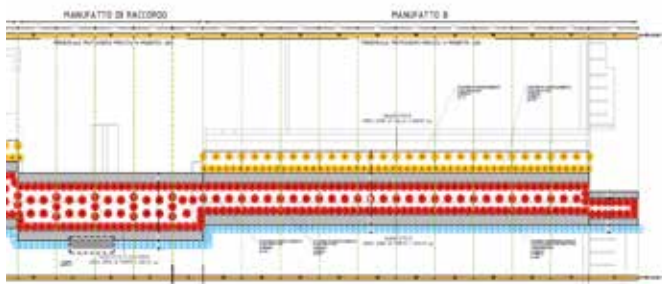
planimetria jet grouting manufatto B e di raccordo: Schermo idraulico (in colore azzurro) e consolidamenti isolati e in affiancamento (colore rosso h 16 m e giallo 11 m)
